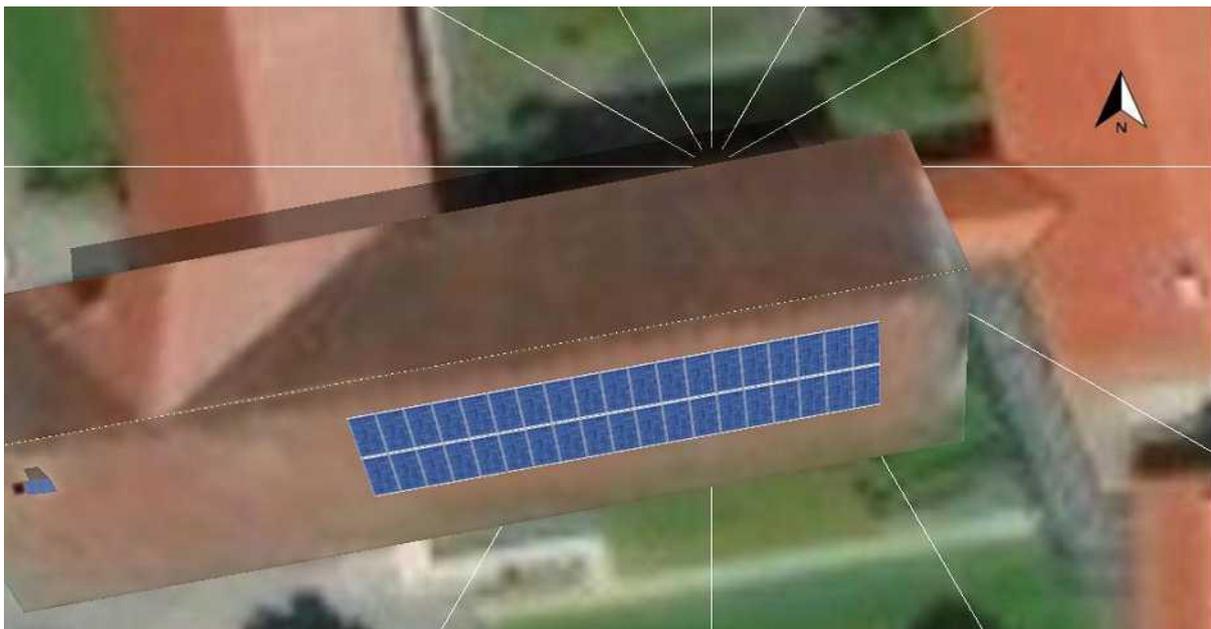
Empfohlene PV-Anlage auf dem Dach der Grundschule.
